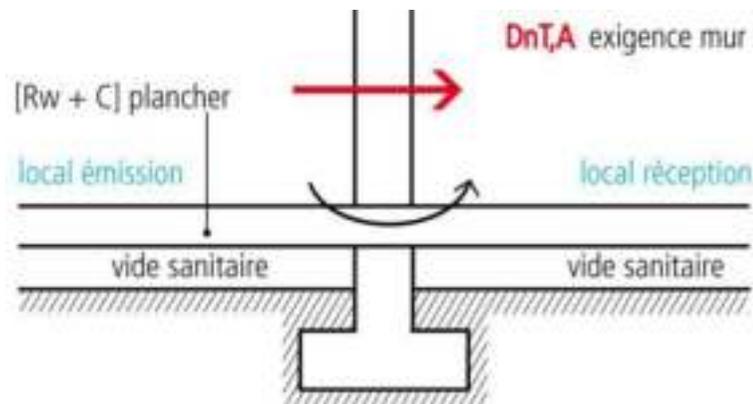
Plancher continu plein ou plancher corps creux sur vide sanitaire et mur lourd simple.
